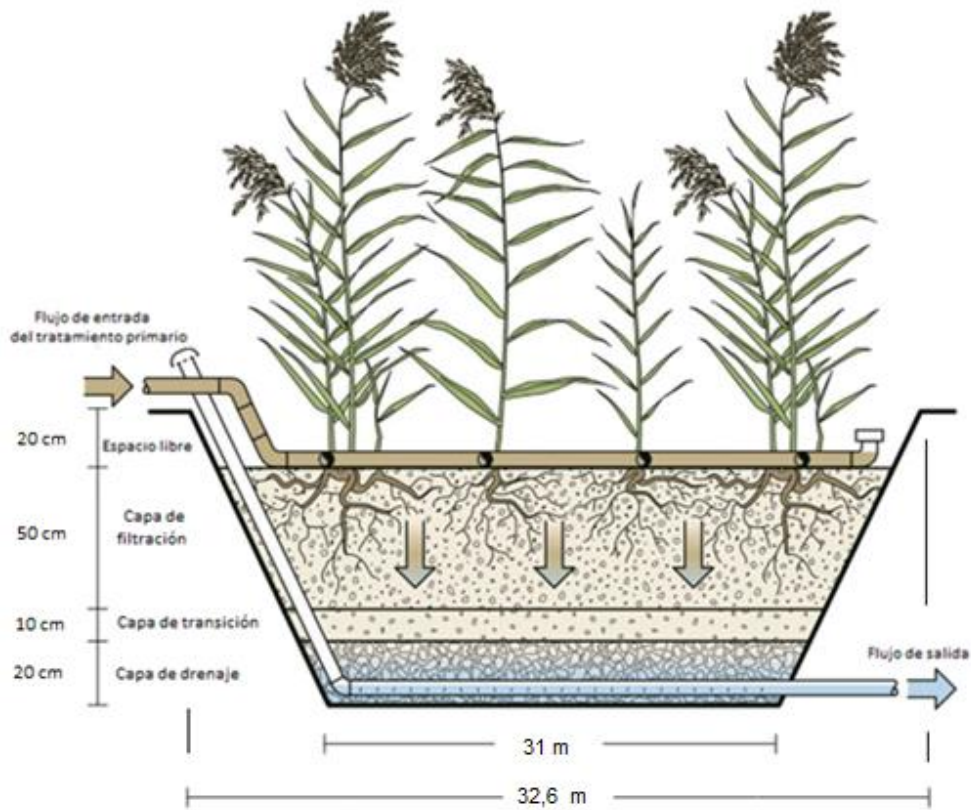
Imagen que muestra las cotas y detalles del humedal calculado sección A-A' y B-B' (no a escala). Fuente: IWA
